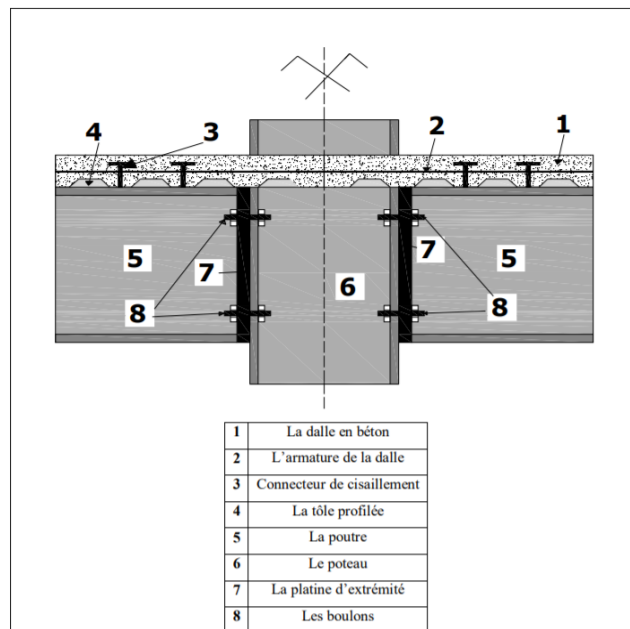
Coupe qui représente l'assemblage Poteau-poutre-plancher
